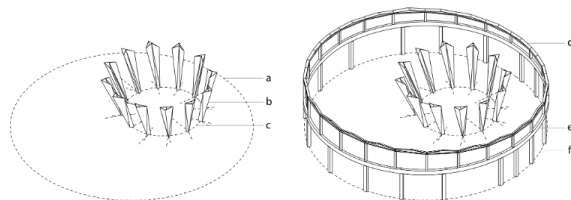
Lay Out dan Potongan Desain Museo Del Acero Horno3
